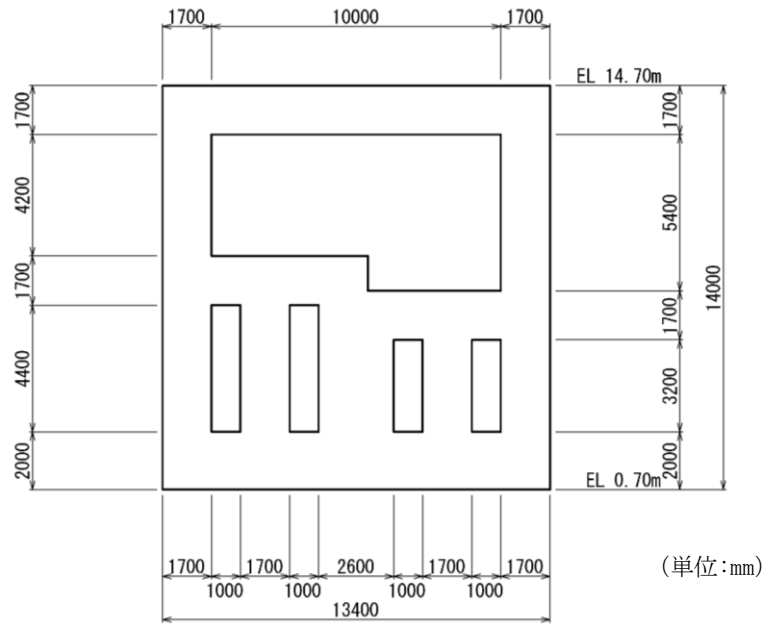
第 1 ベントフィルタ格納槽 断面図 (B-B 断面)
